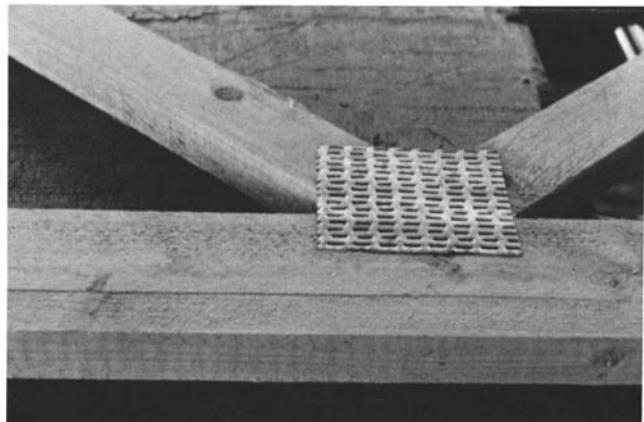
Collecteur mécanique « Gang nail ». Etablissements Alpes-bois-construction — Beaucaire (Gard). Photo D. M.
